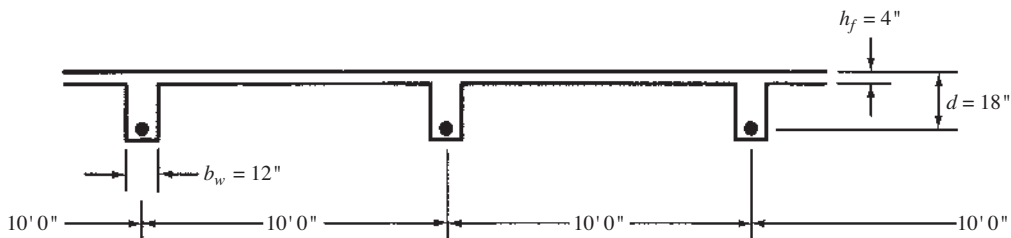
Sección transversal de un sistema de piso con vigas T del Ejemplo 5.4.
